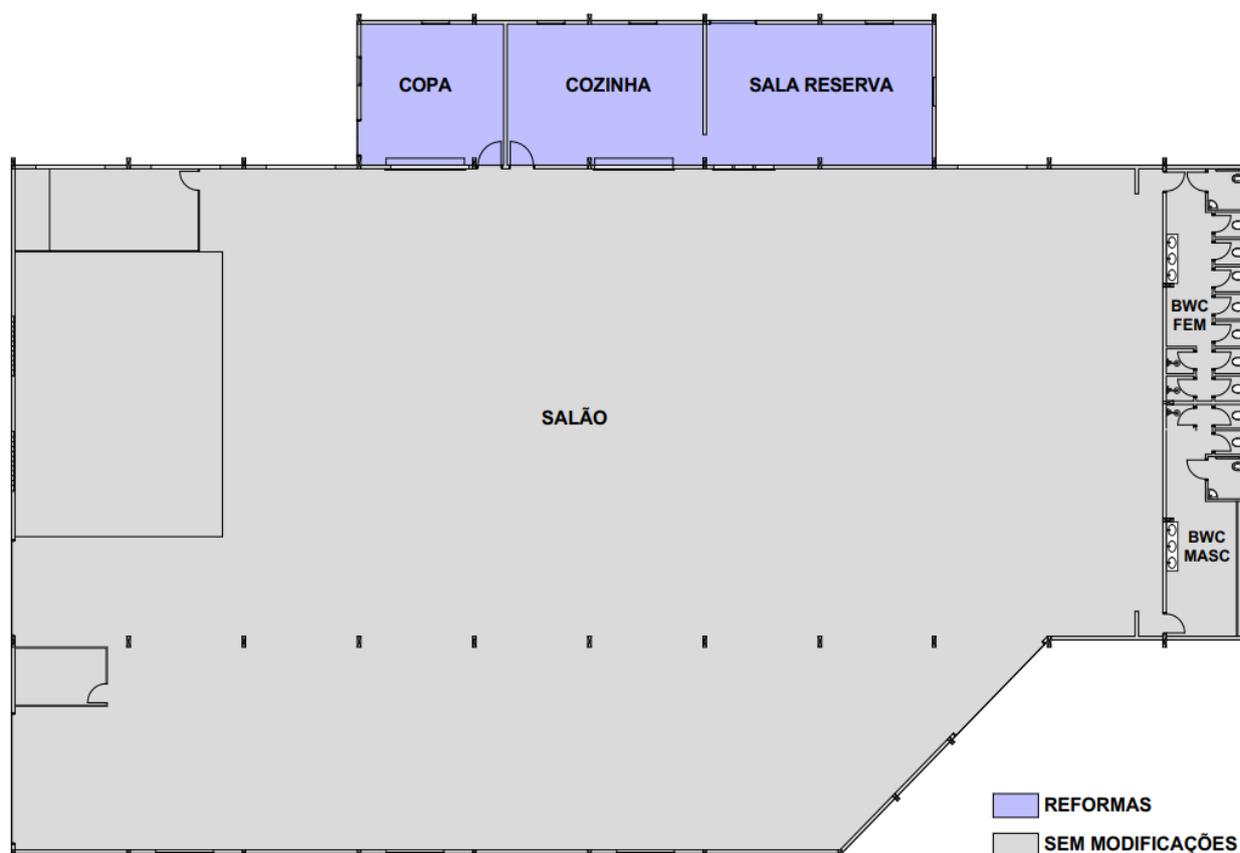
Planta Baixa do Pavilhão – Identificação de áreas
